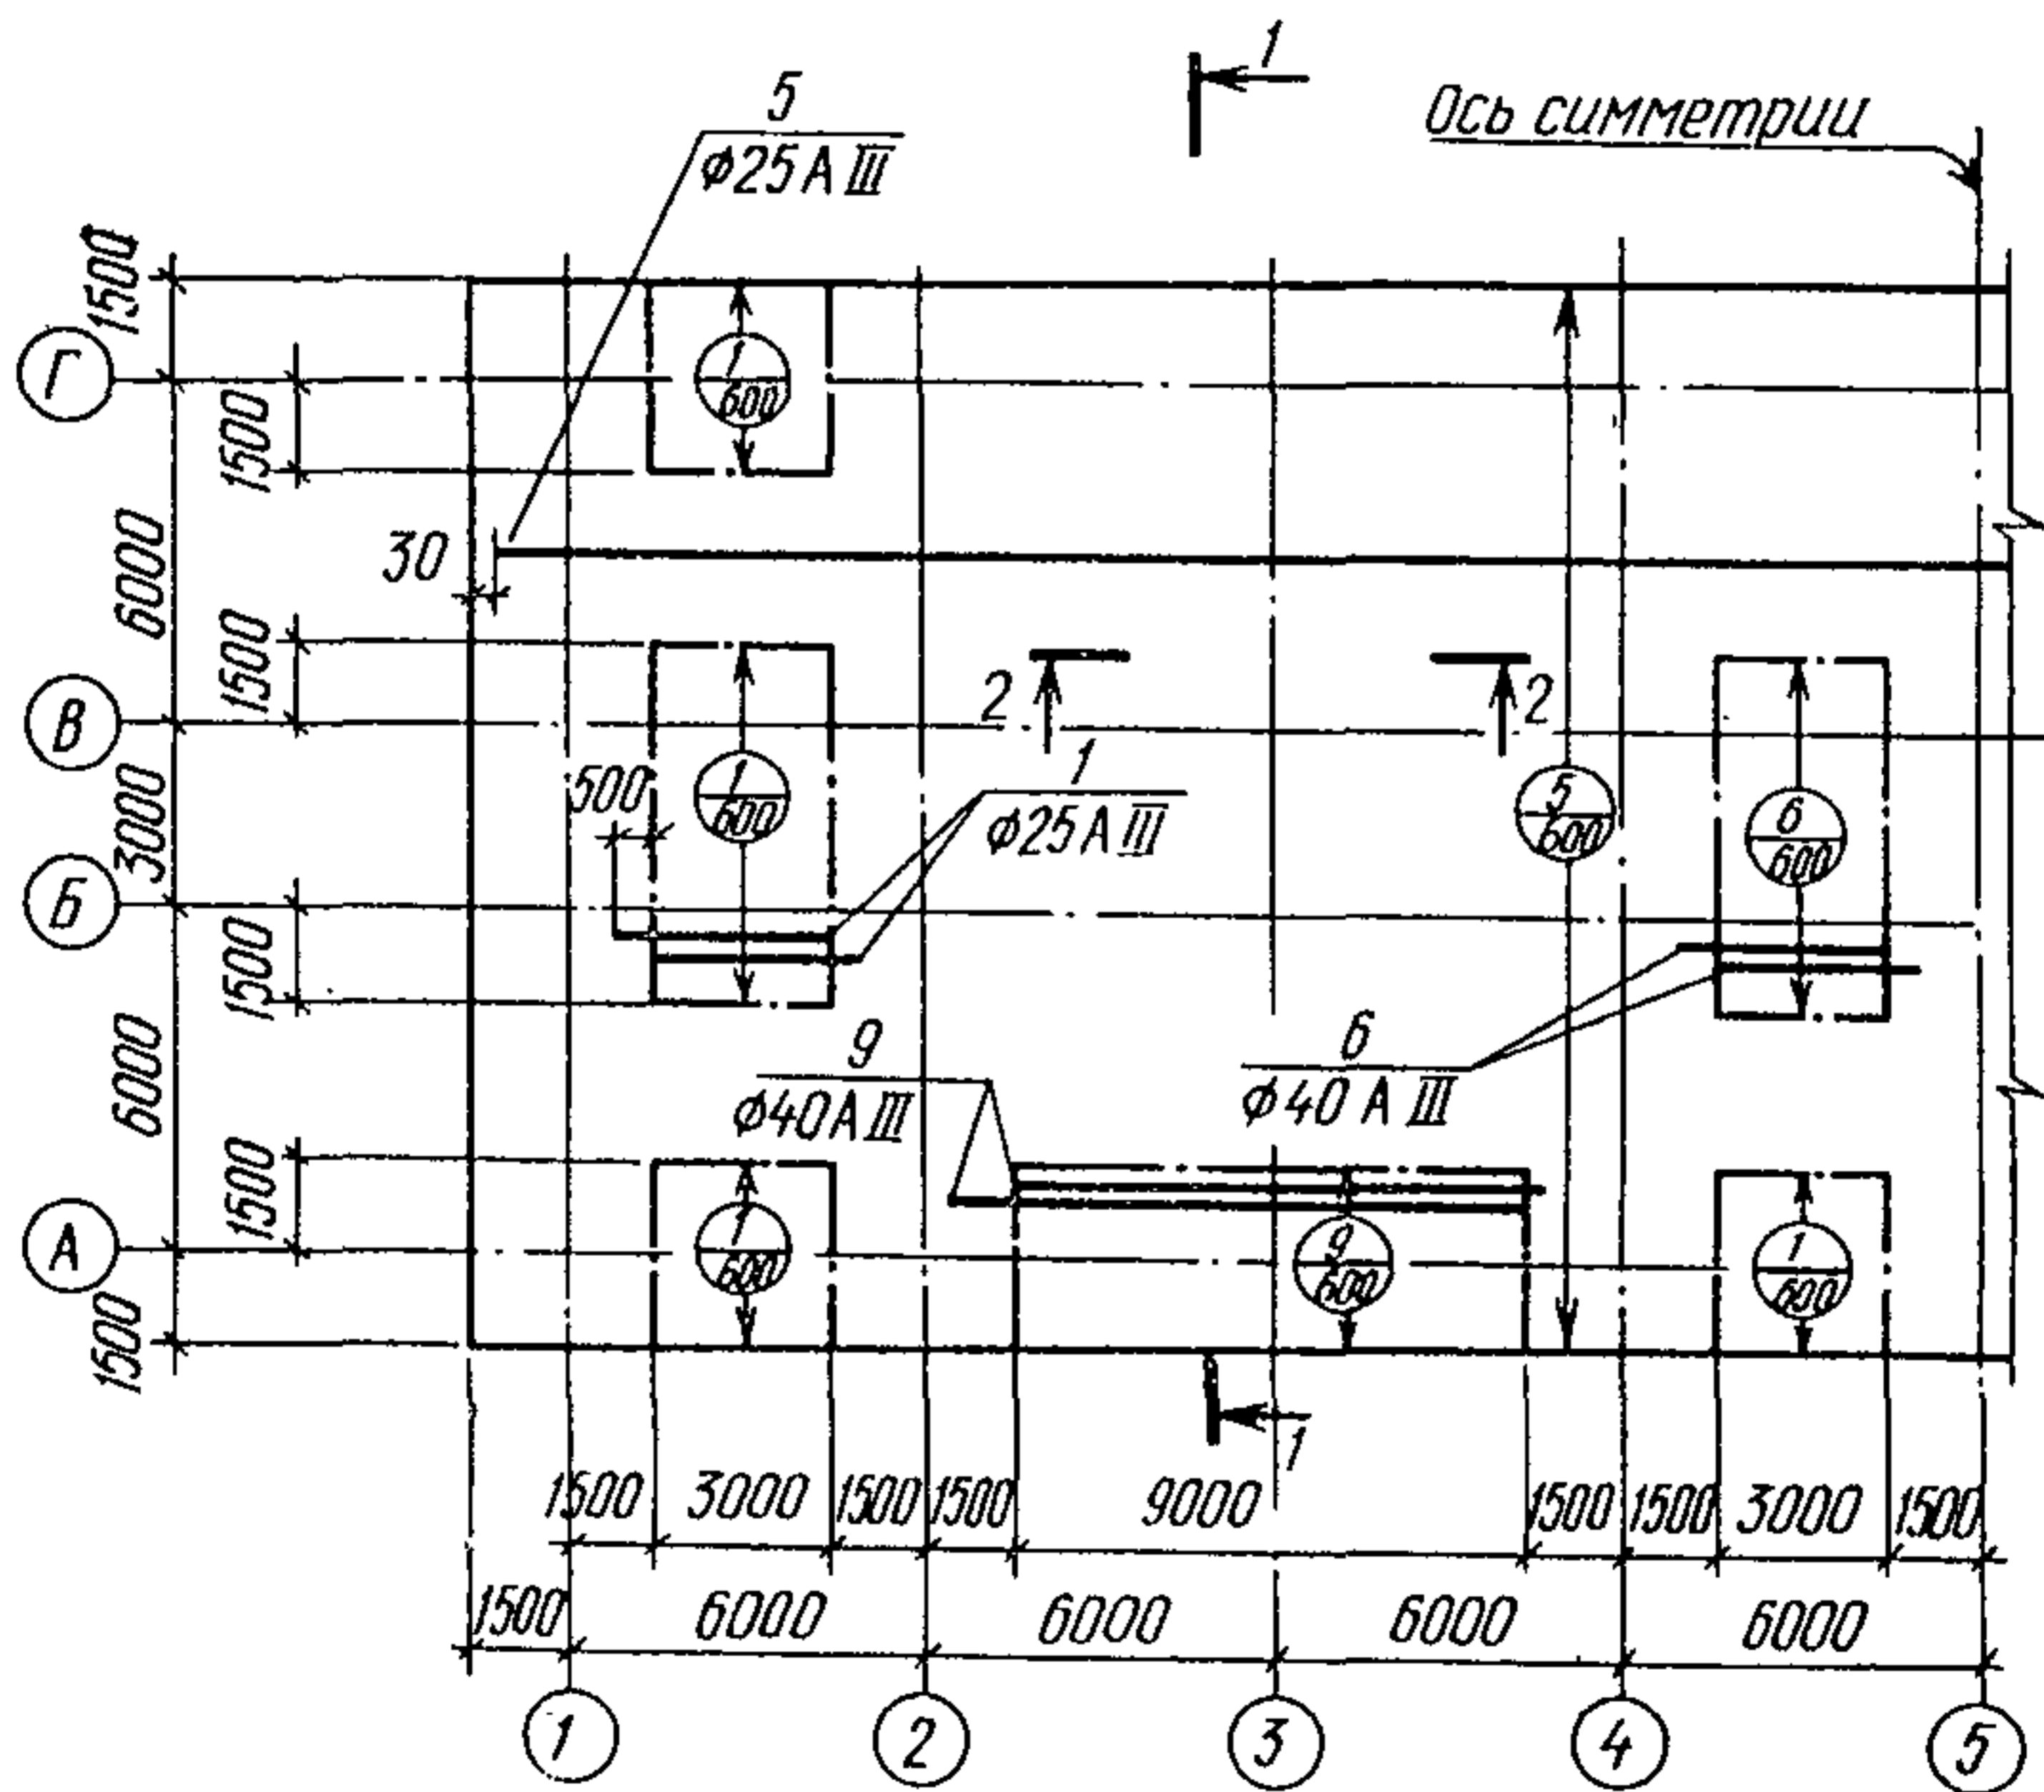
План раскладки арматуры первого слоя верхней зоны
